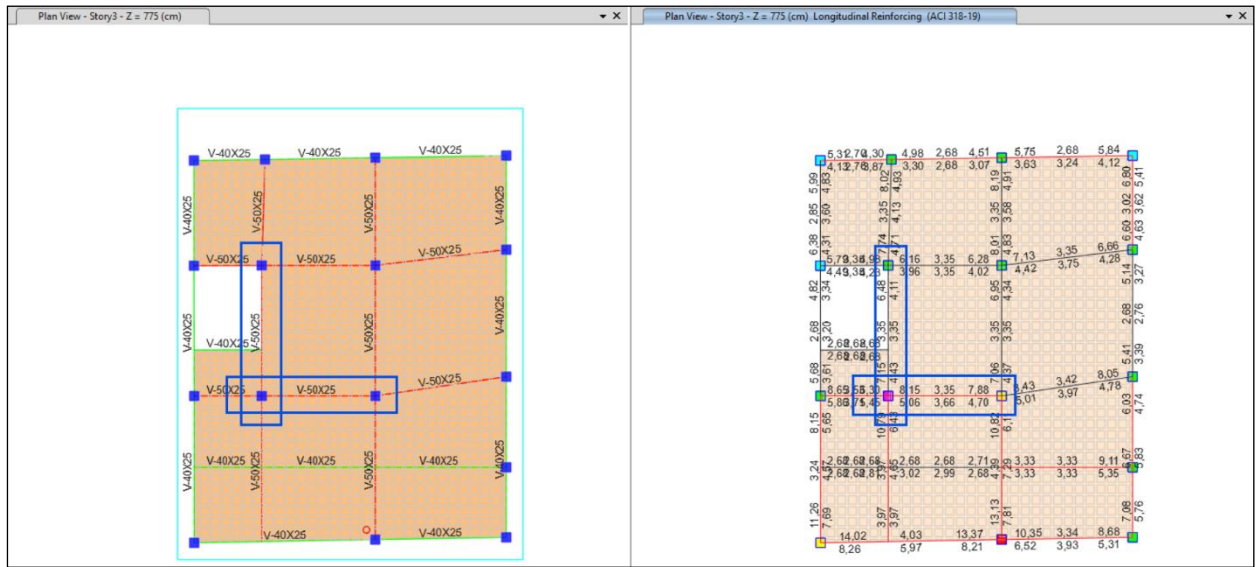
Acero a flexion en vigas de losa nivel 2, alternativa 2 [Autor]
